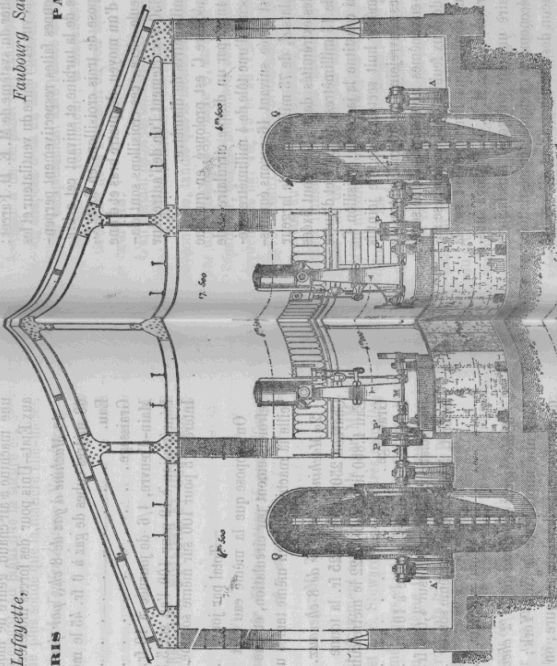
Vue d'ensemble des ventilateurs et des moteurs.
